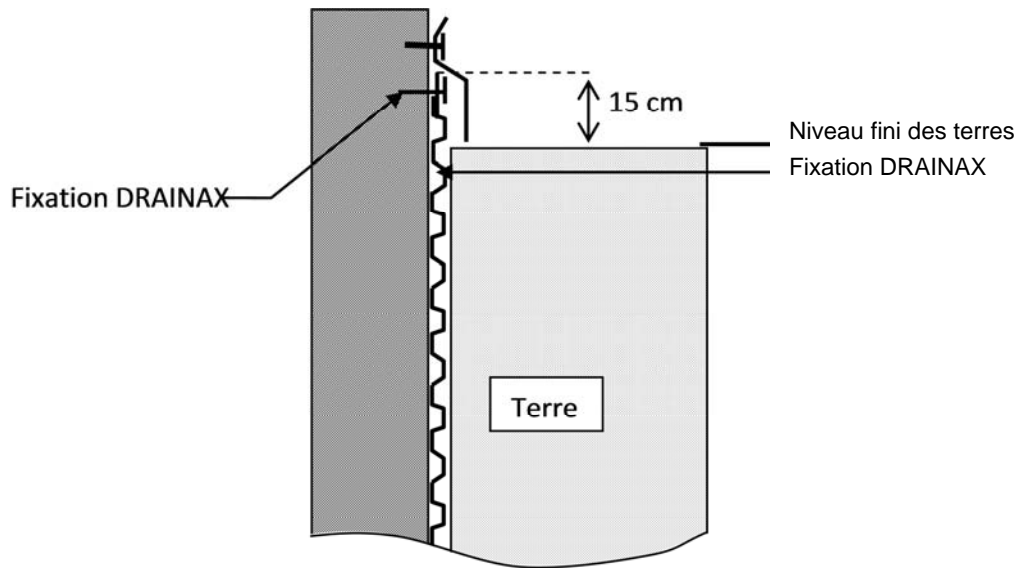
Arrêt supérieur du DRAINAX sur support nu ou enduit
